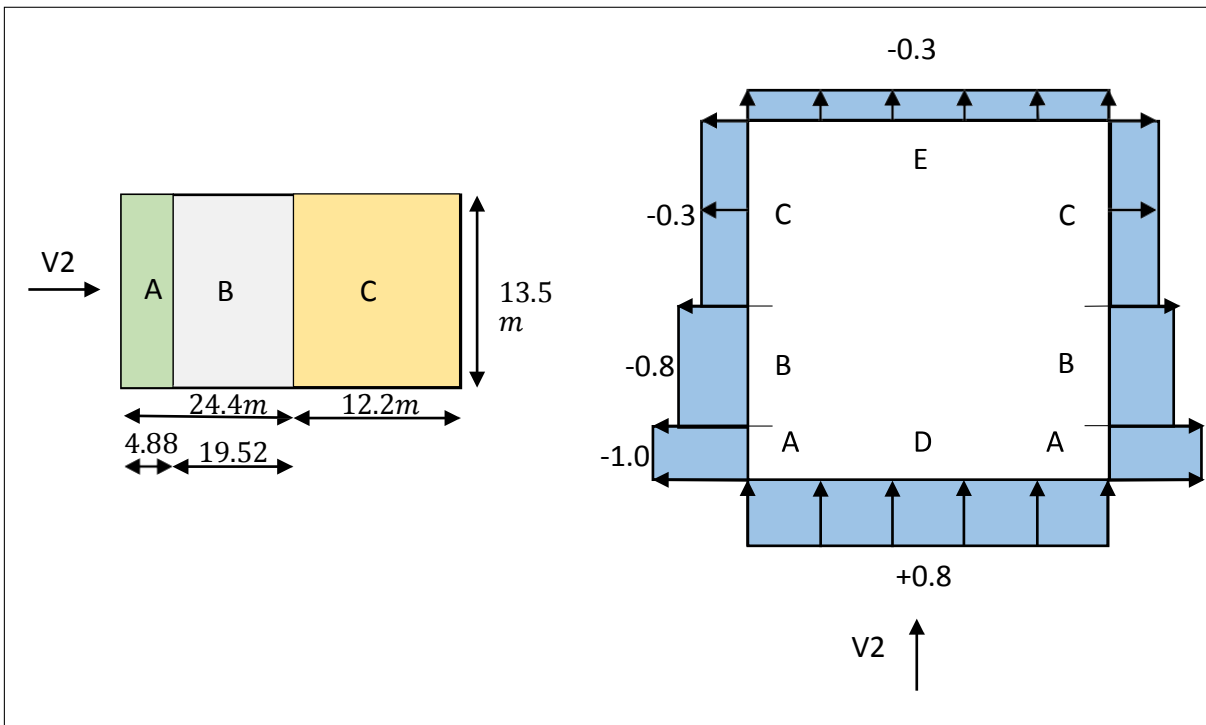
Vue en plan des zones de pression sur les parois verticales suivant le pignon.
